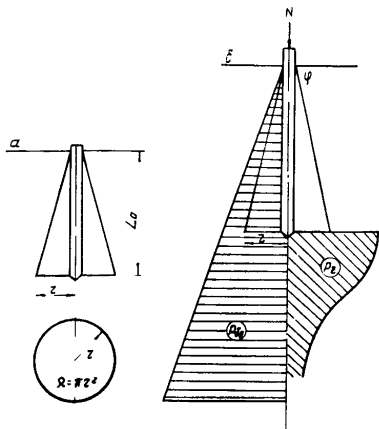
Схема к расчету одиночной висячей сваи по деформациям:
